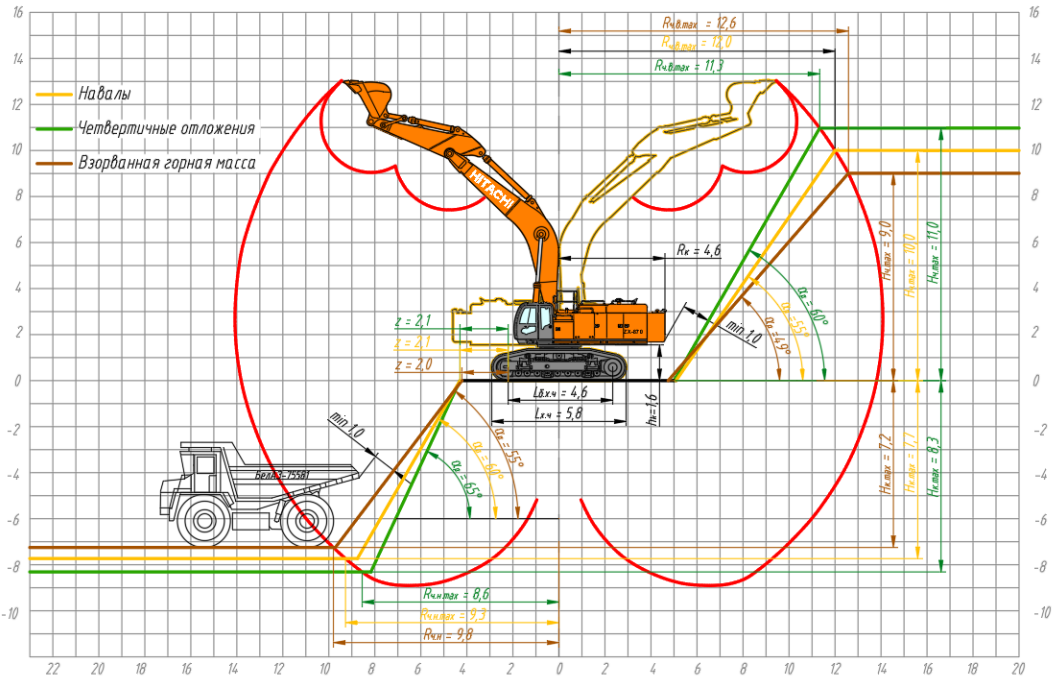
Кинематическая схема движения ковша экскаватора Hitachi ZX-870
